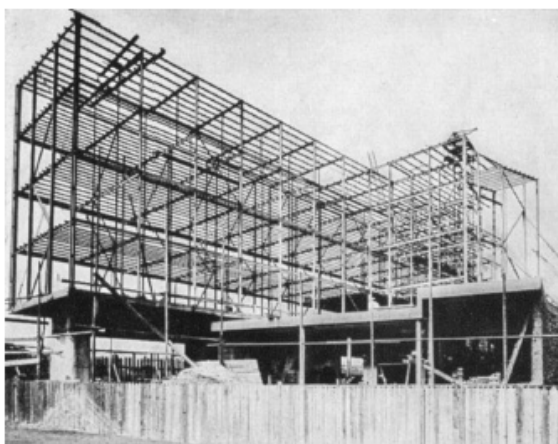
Pavilhão Suíço, Paris, França, 1931. Arquiteto: Le Corbusier. Construção, estrutura metálica sobre embasamento de concreto.
